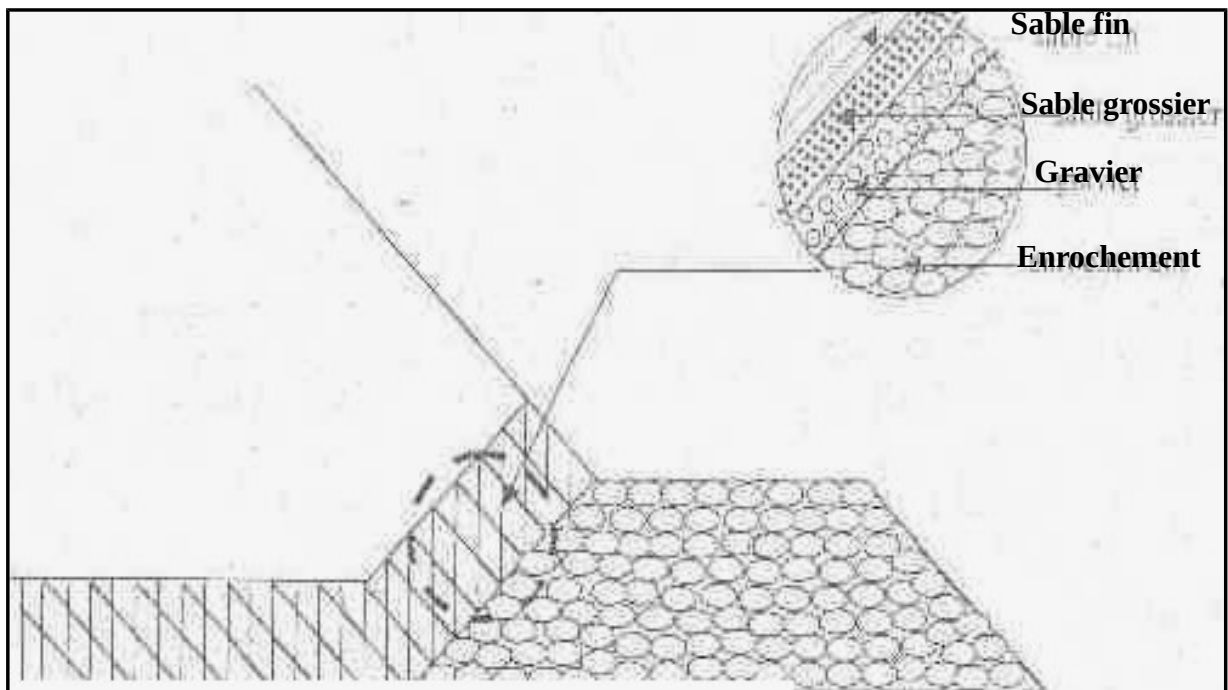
tapis filtrant, cas des fondations imperméables
